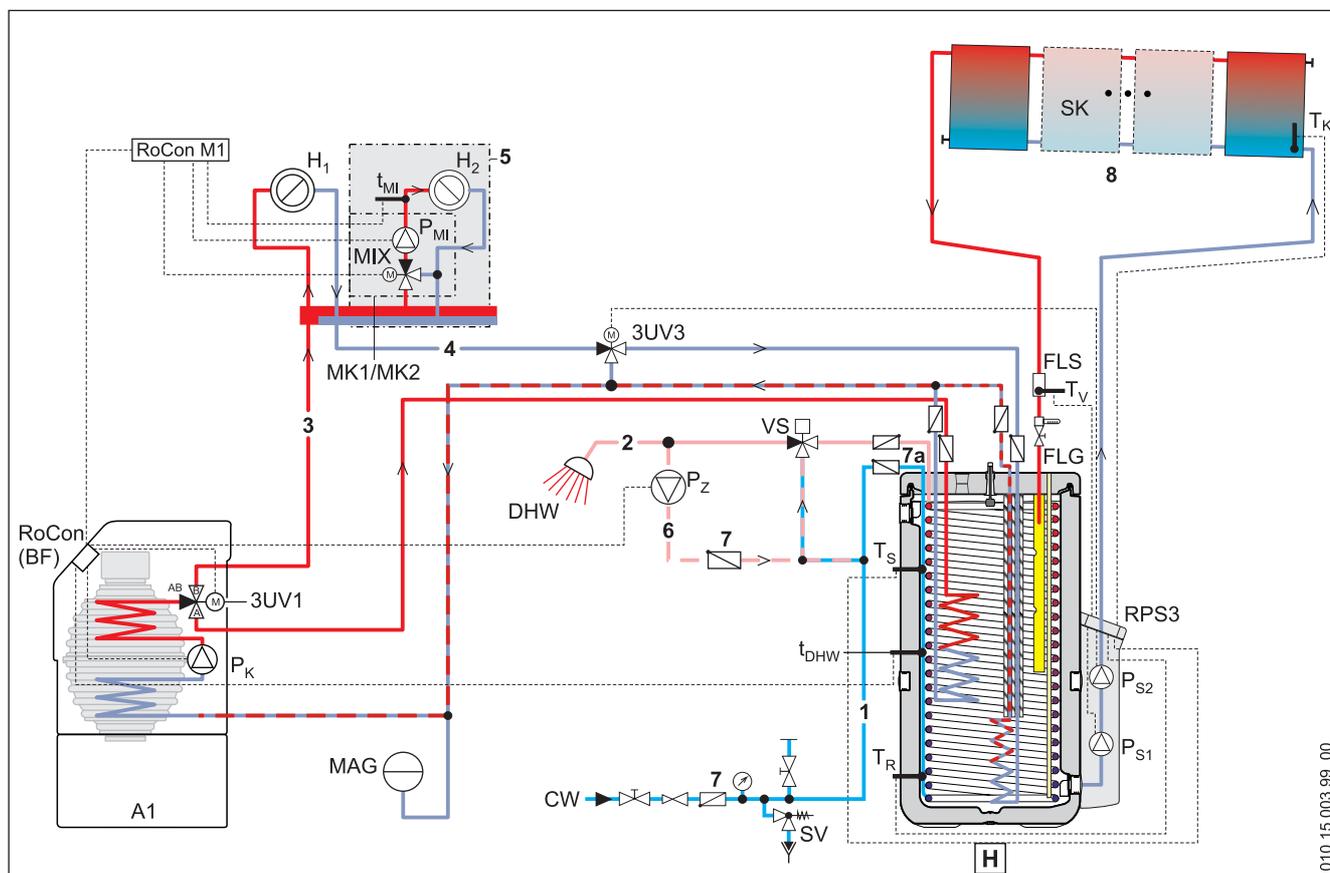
Schema di collegamento standard con caldaia a condensazione A1 e sistema solare DrainBack senza pressione<sup>1)</sup>  $p=0$  (vedere legenda tab. 6-1)
